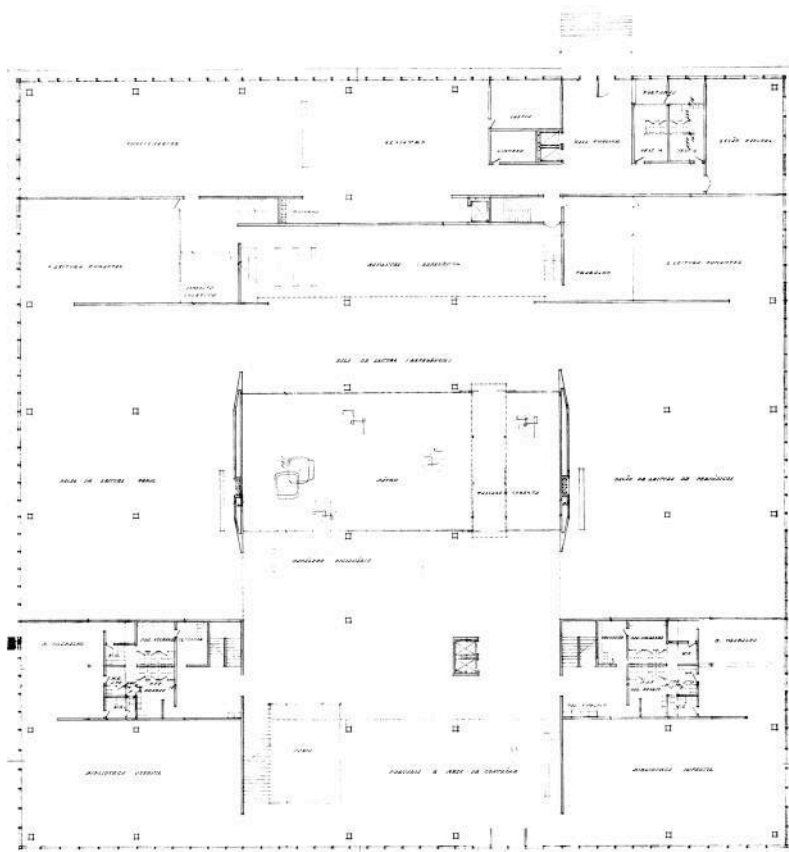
Planta baixa – térreo, Biblioteca Nacional Brasília, 1960. Fonte: Arq.PDF.
